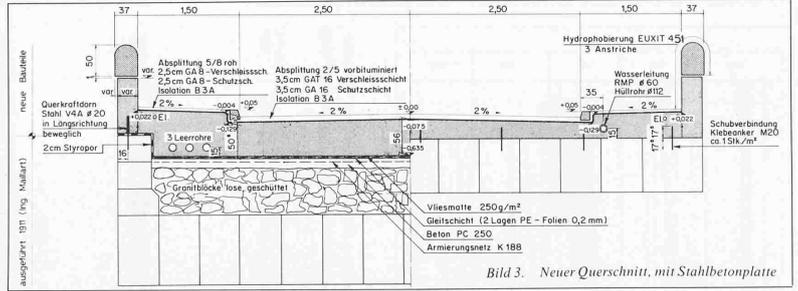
Neuer Querschnitt, mit Stahlbetonplatte
